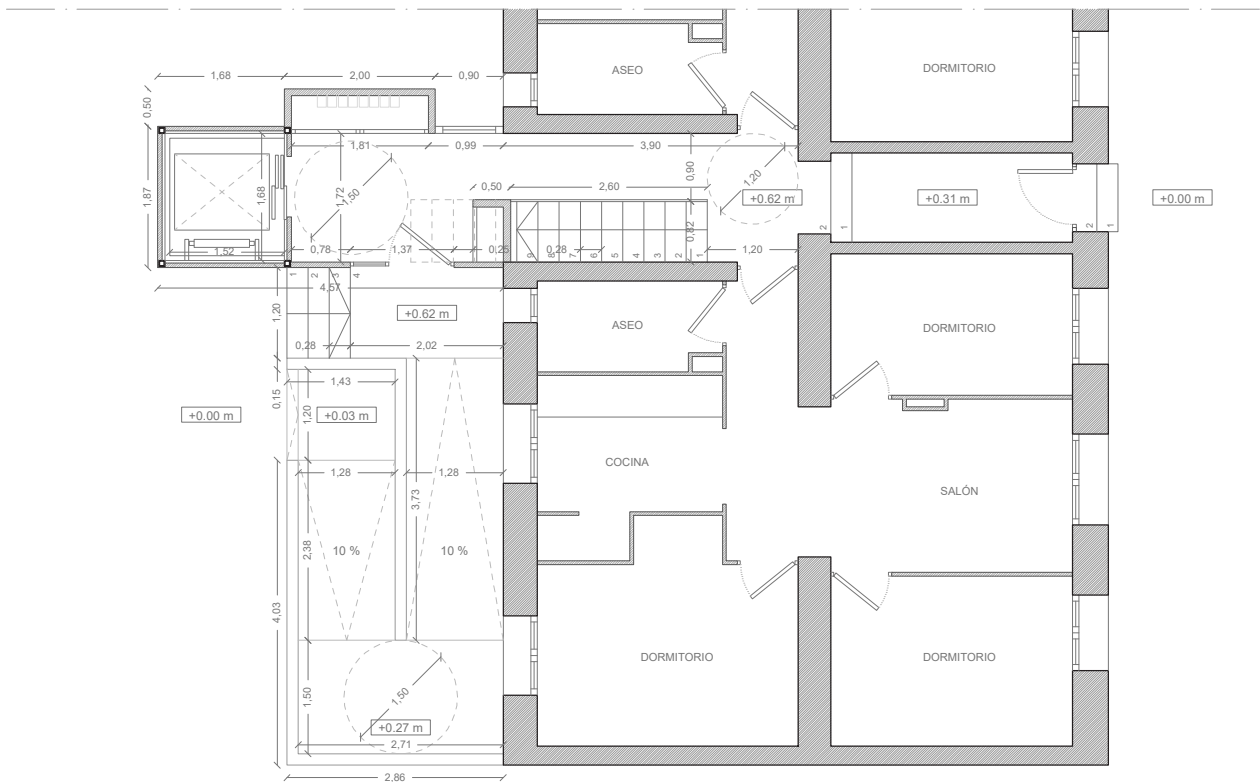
Zoom núcleo planta baja (e: 1/100).
